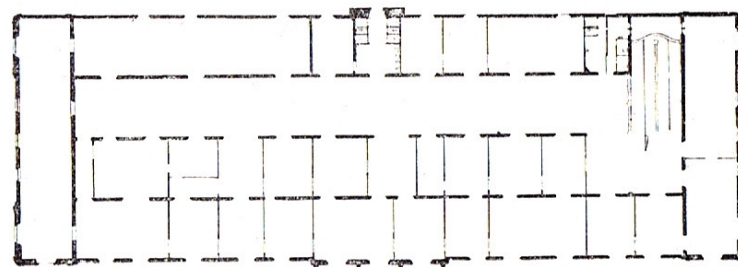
Estación del Ferrocarril Central — Planta alta.
